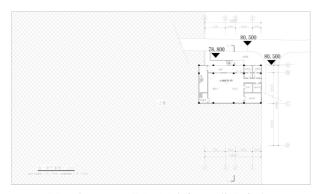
负一层平面图(图片来源:作者自绘) Fig. 4 Negative floor plan
